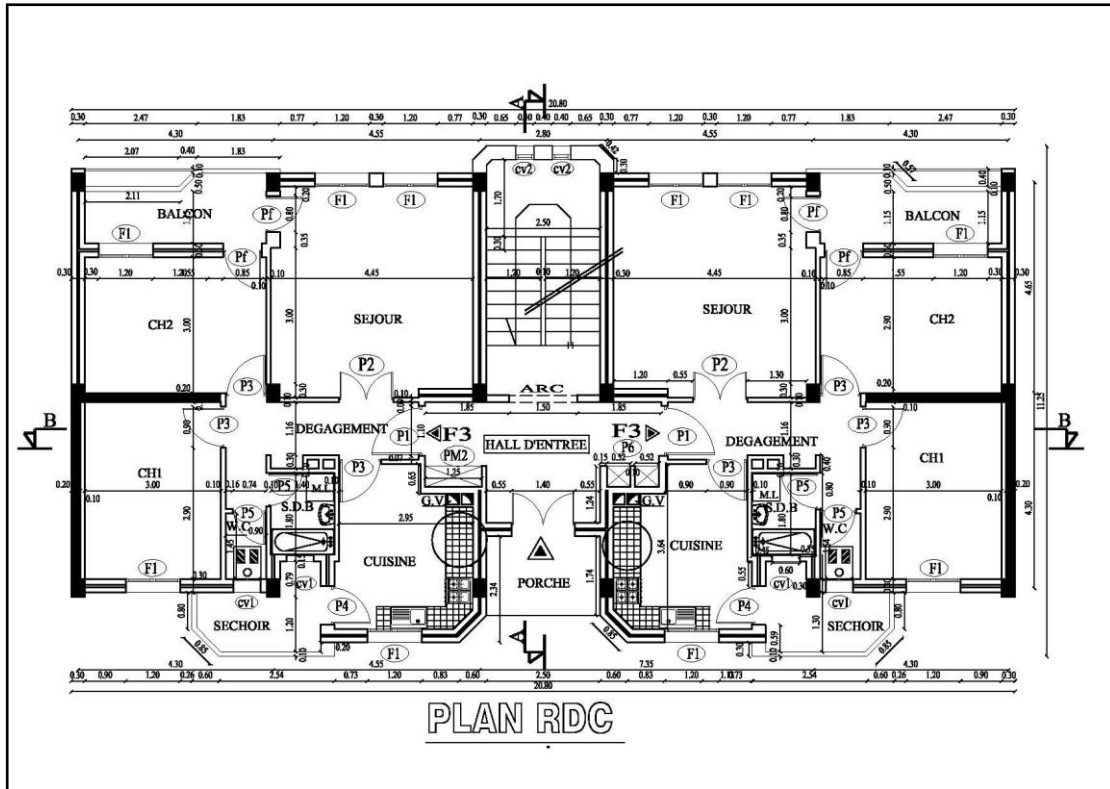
Plan RDC d'un logement collectif à Jijel.
